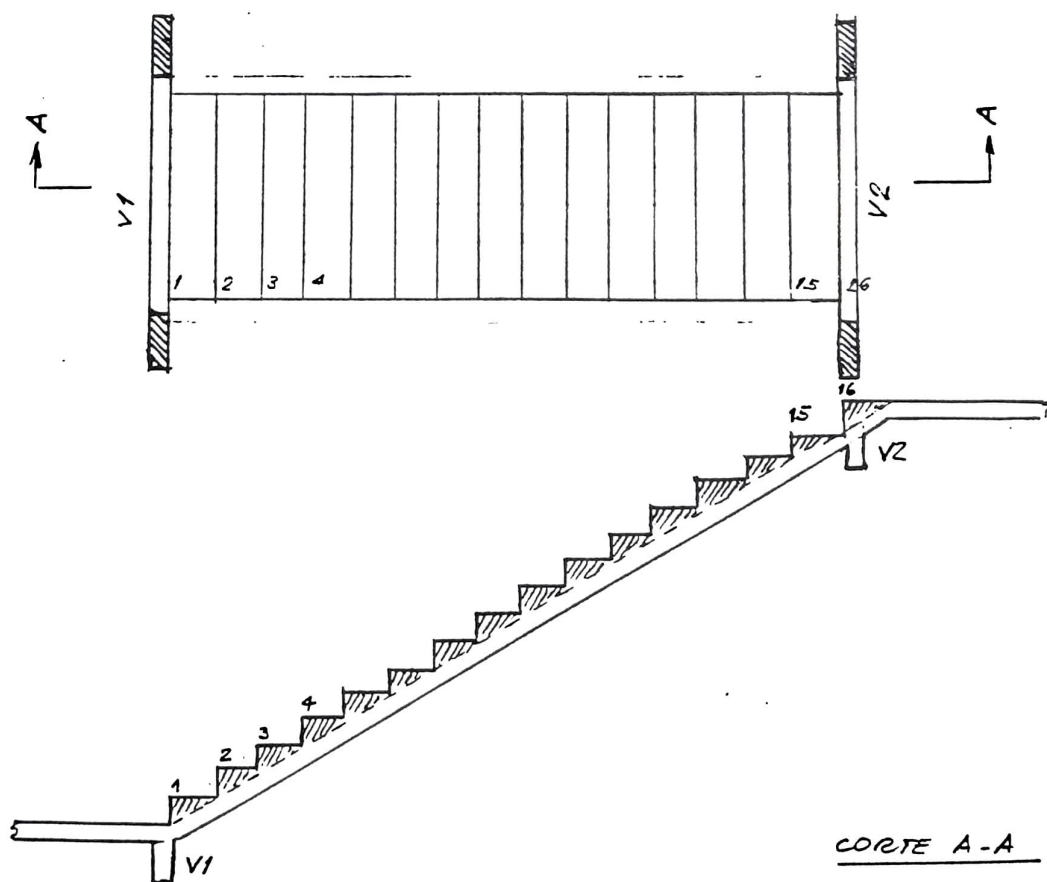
Exemplo de uma escada em laje armada longitudinalmente e apoiada em duas vigas. (caso fundamental)
